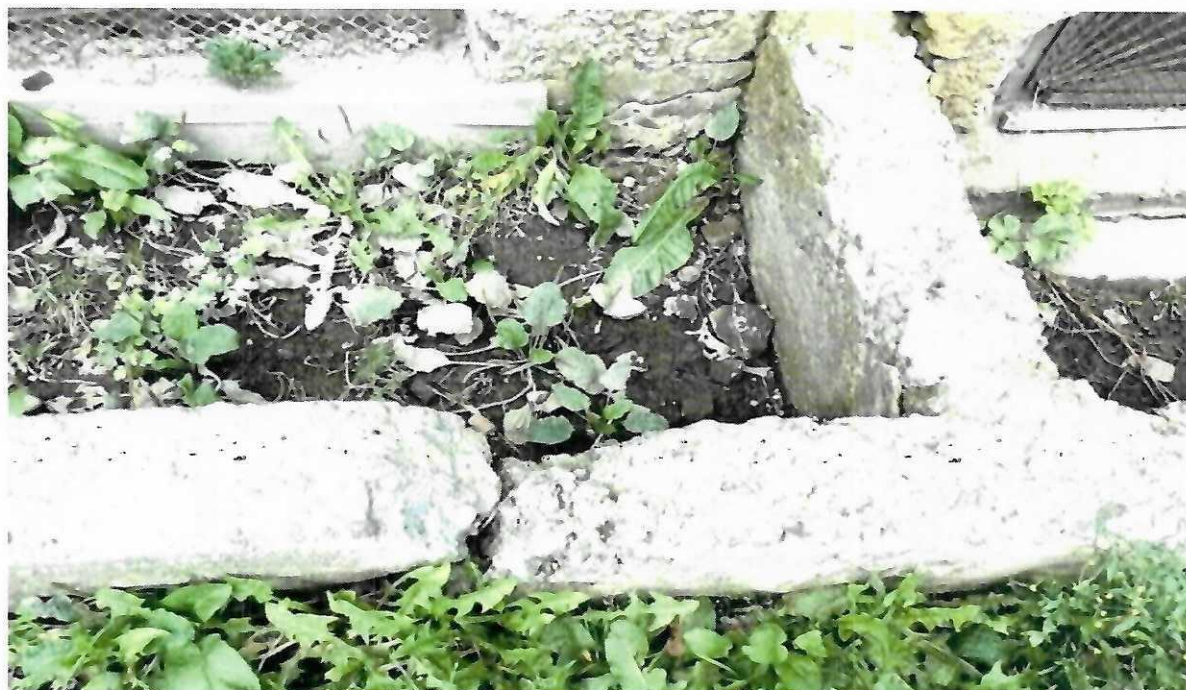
Состояние приямка цокольного этажа: отсутствие бетонного основания днищ приямков, не предусмотрен дренажный выход, разрешения бетона стенок приямка.
